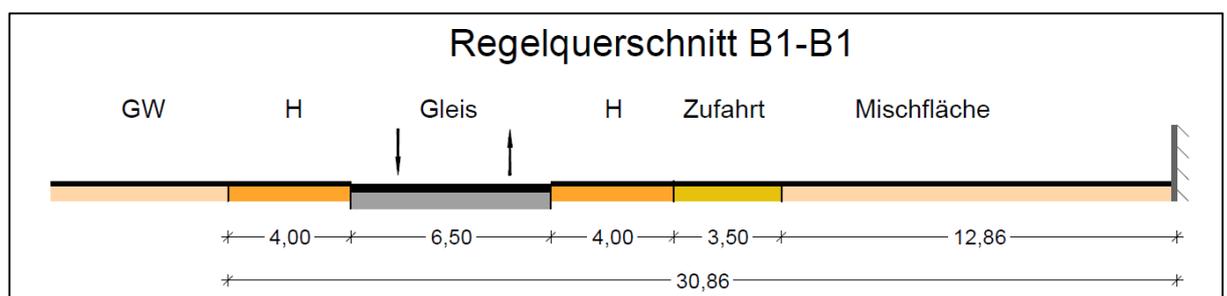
BS geplanter Querschnitt Haltestelle Stadthalle (Angaben in Meter)
